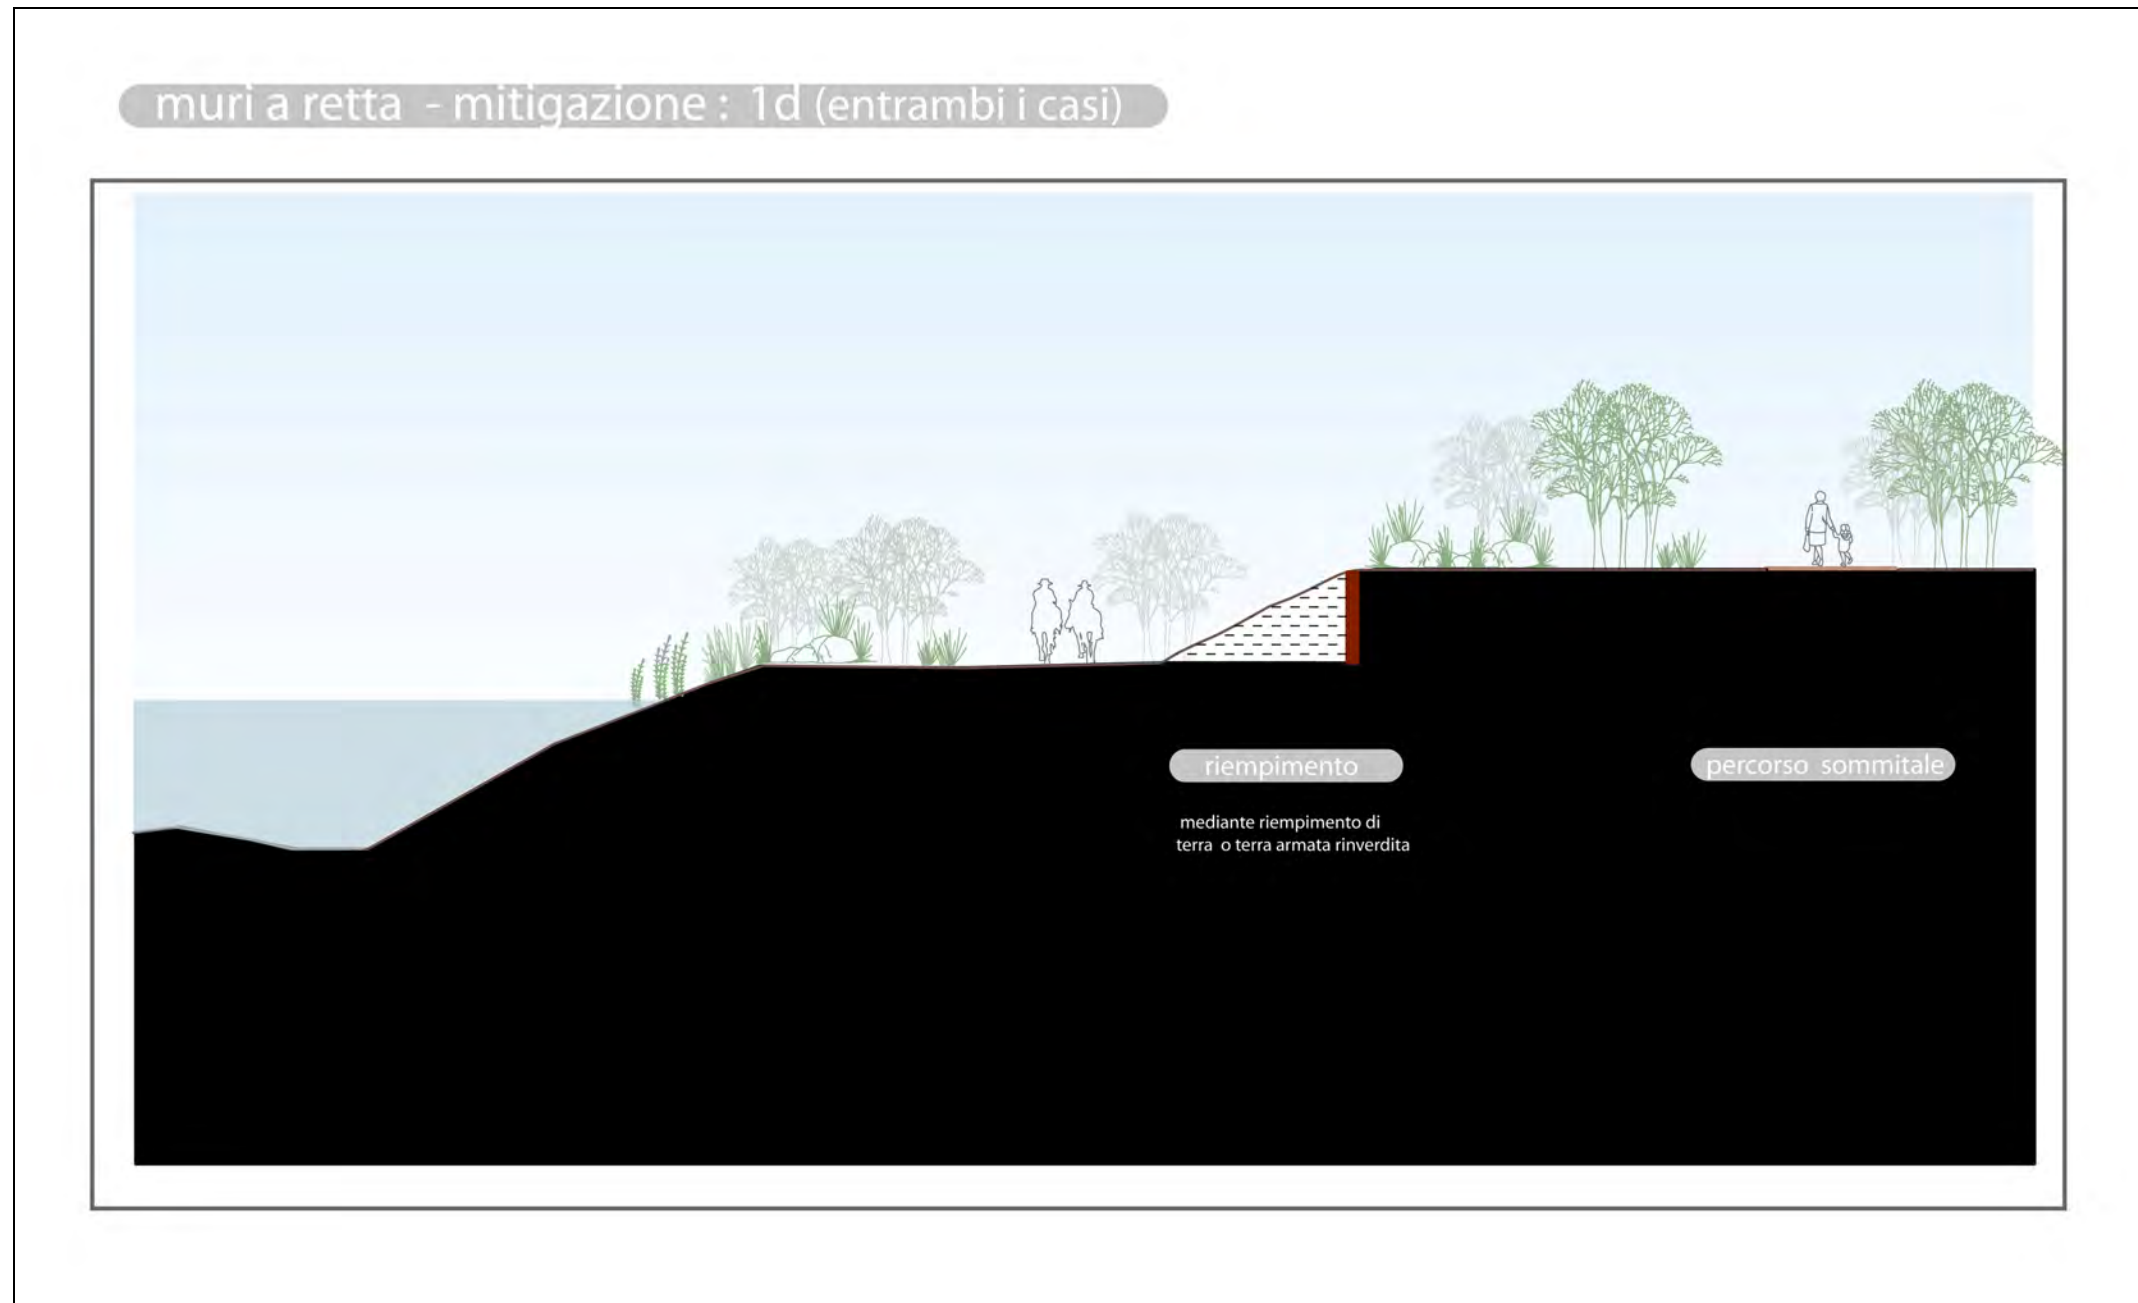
Caso 1.d con la mitigazione del muro a retta.
